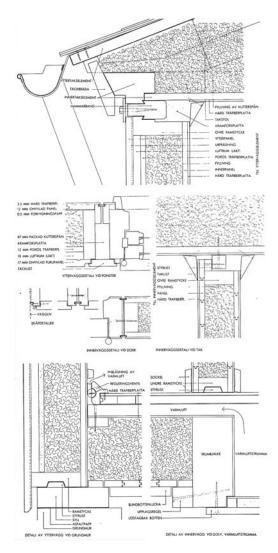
Sven Markelius. Sección constructiva de la casa del arquitecto en Kevinge, 1945. (Markelius, 1946)
